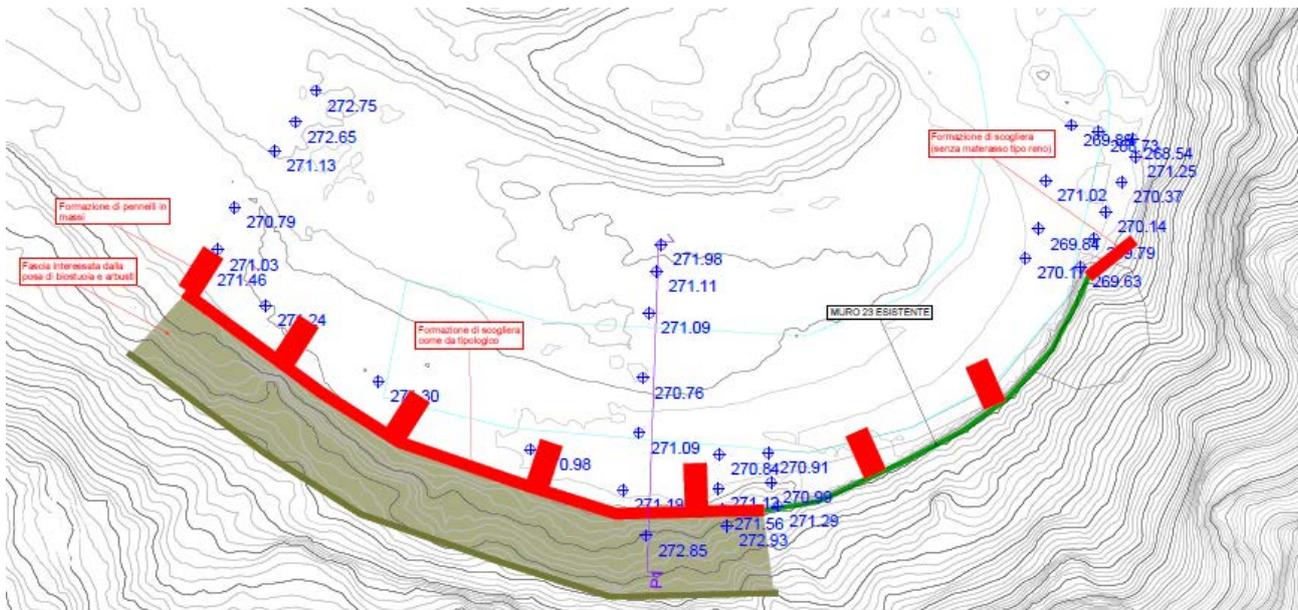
ESTRATTO PLANIMETRIA DI PROGETTO MURO 23 – IN ROSSO LE NUOVE OPERE IN MASSI PREVISTE
